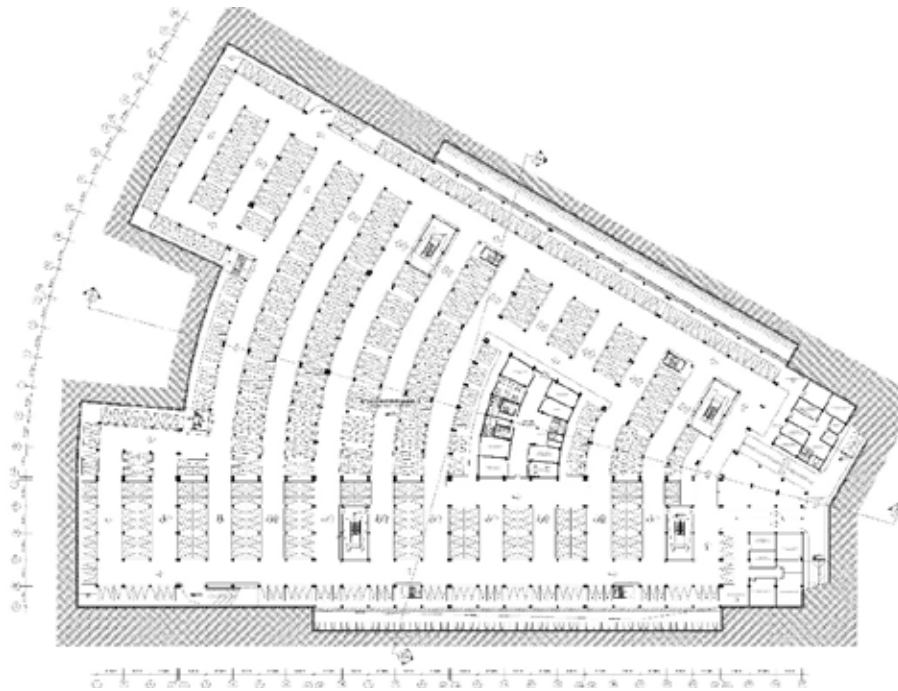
Planta de Sótano. Nivel -3.40m (2016)
